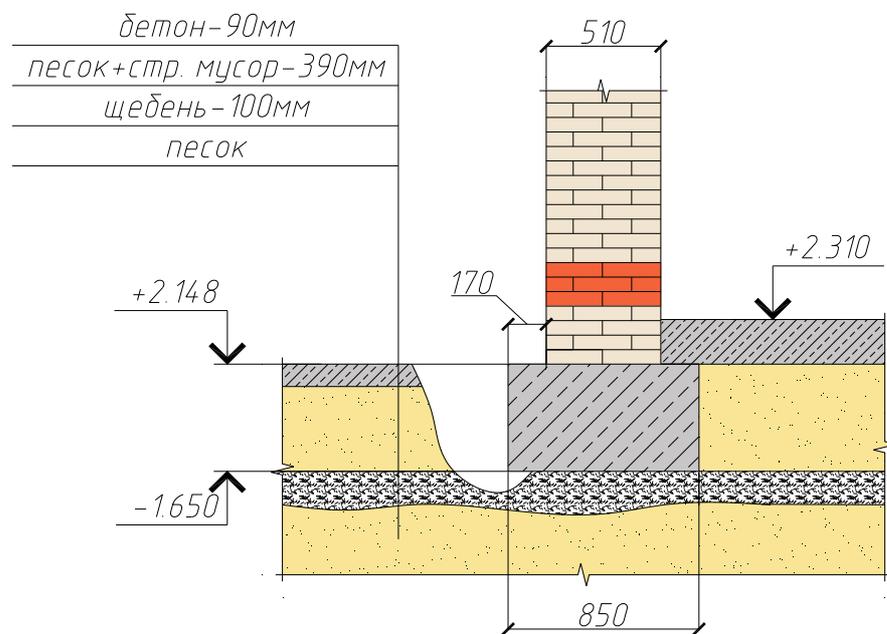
Эскиз поперечного сечения фундамента.
